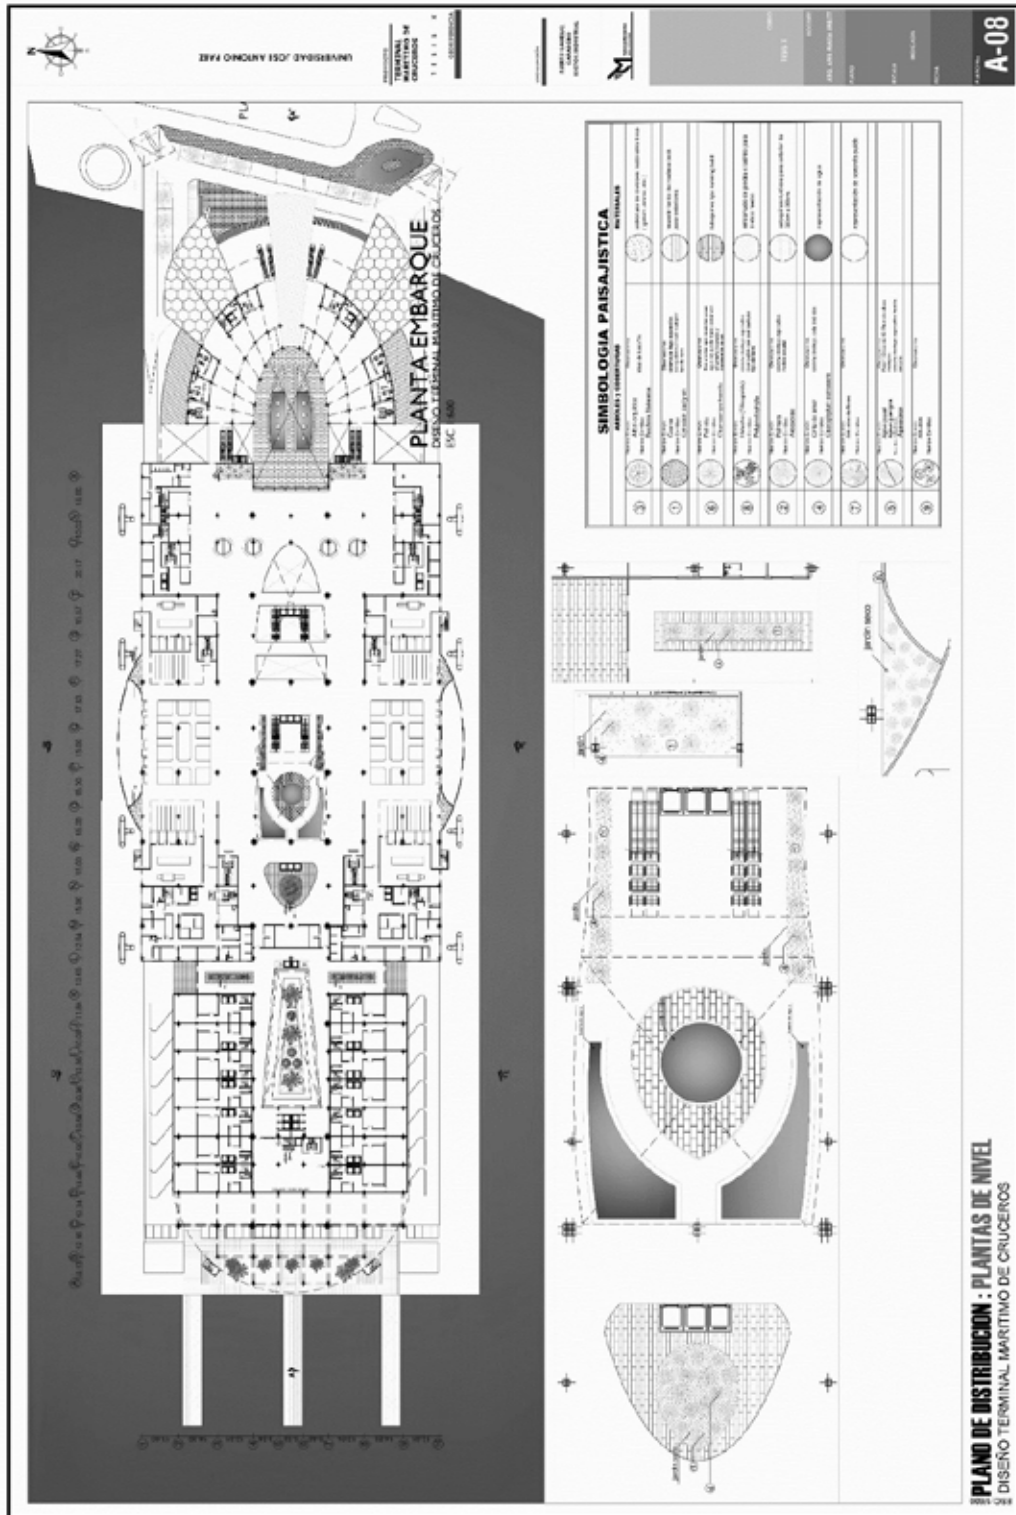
Plano de paisajismo de planta embarque (Nivel +7.75)
